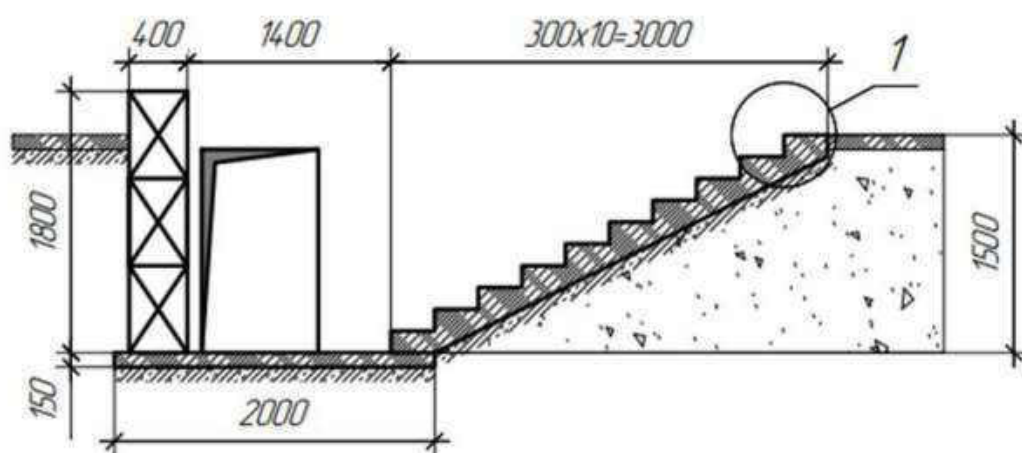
Схема устройства лестничного спуска (ступеней) в подвал
